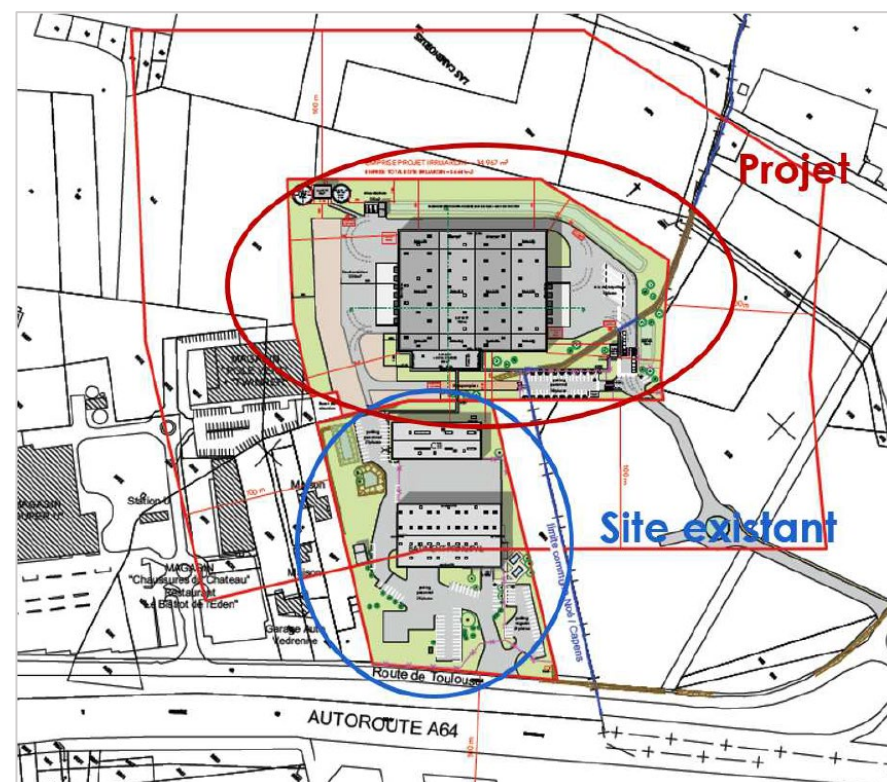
Plan de masse global du site IRRJARDIN : Site existant et futur site, source DDAE Irrijardin / Bureau Veritas Exploitation
